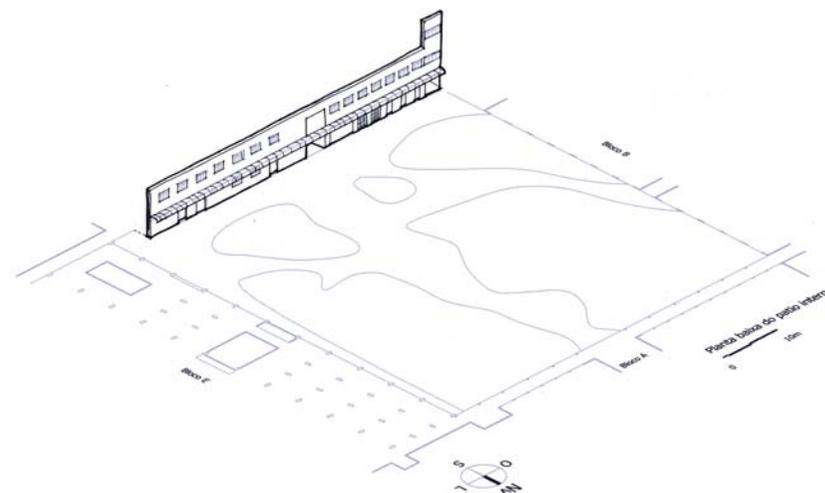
Estudo dos planos verticais, fachada Sul do pátio interno do CEFET.
